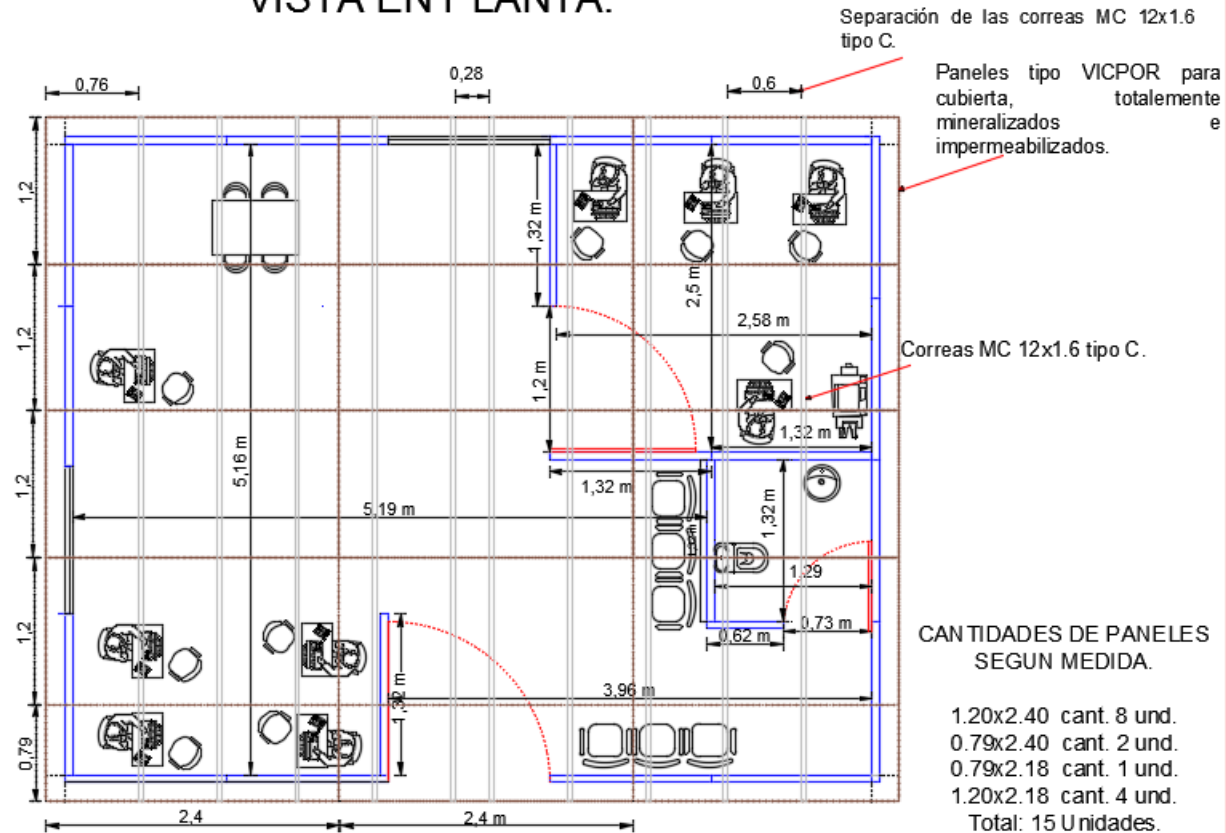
Ejemplo plano ubicación de correas y paneles para cubierta, vista en planta.
